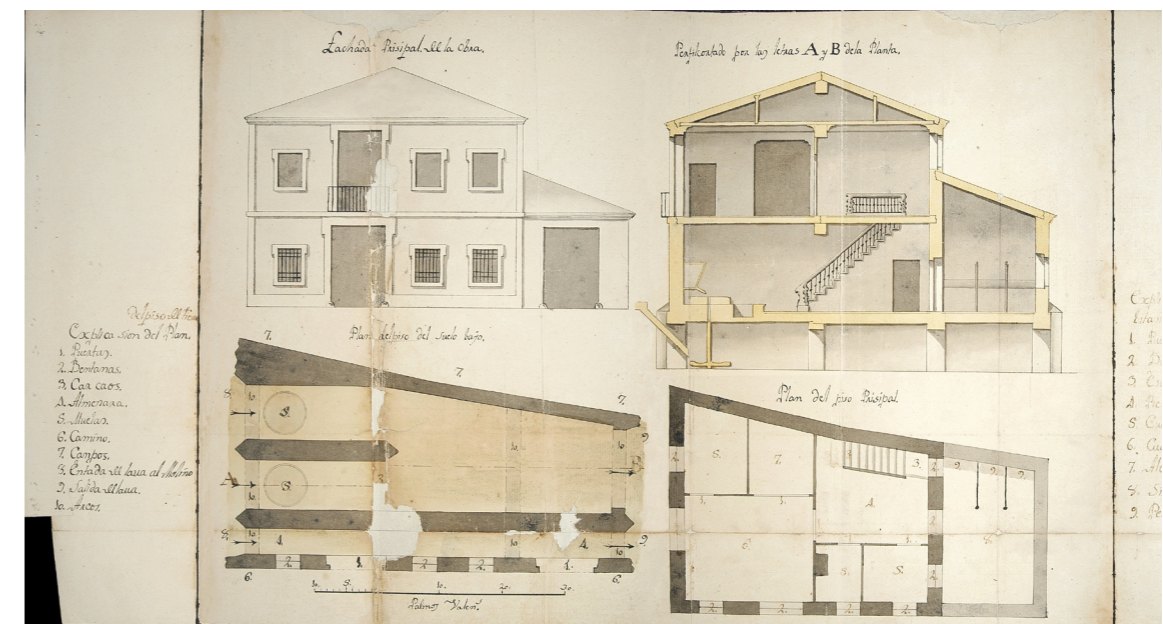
Plano del molino harinero. Archivo del Reino de Valencia. Facilitado por la familia Dolz Arenas
